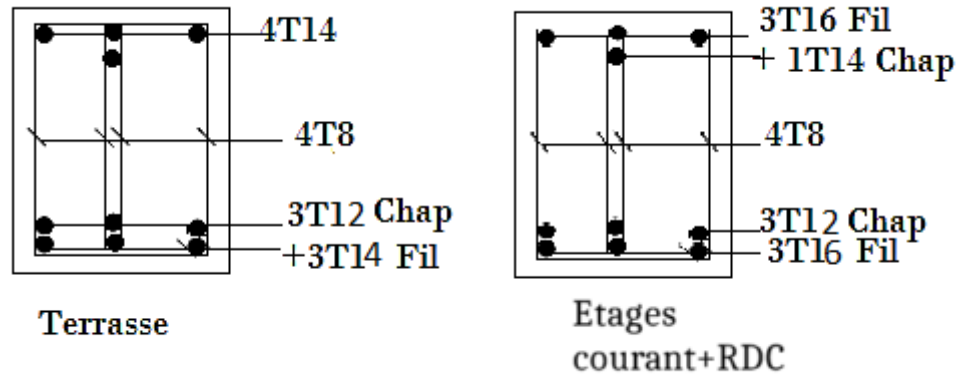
Dessin de ferrailage des sections des poutres principales
